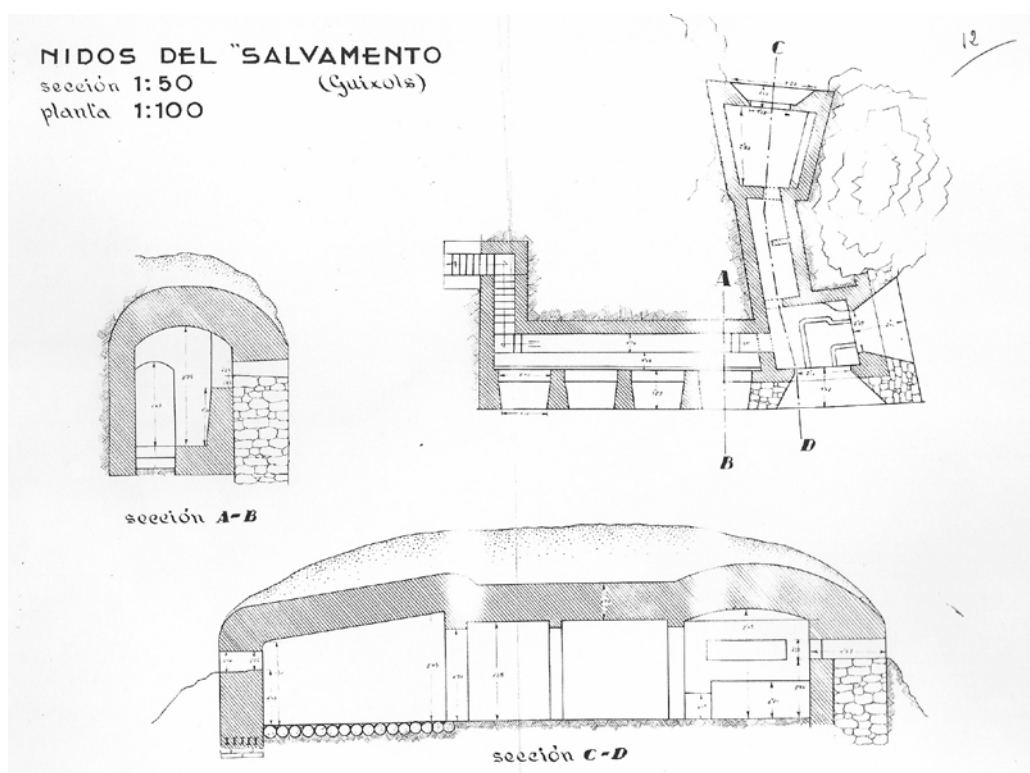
Plano de Nido con secciones donde se observa la utilización de diversos materiales: hormigón mampostería y madera. Arxiu Municipal de Sant Feliu de Guíxols, procedentes del Archivo General Militar de Ávila.
